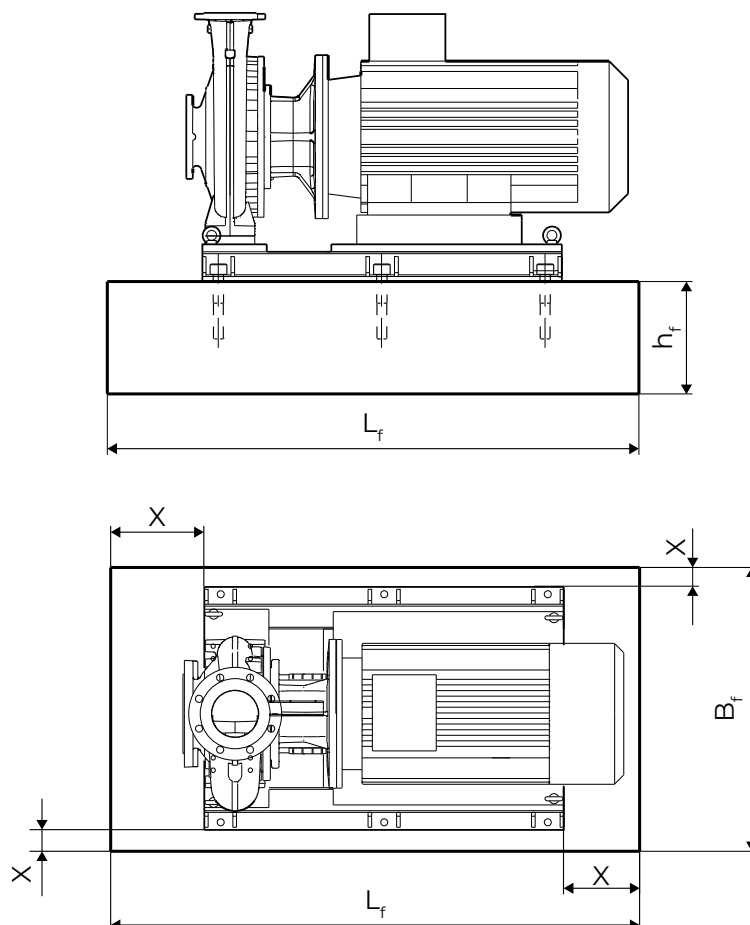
Размеры фундамента для насоса с рамой-основанием
